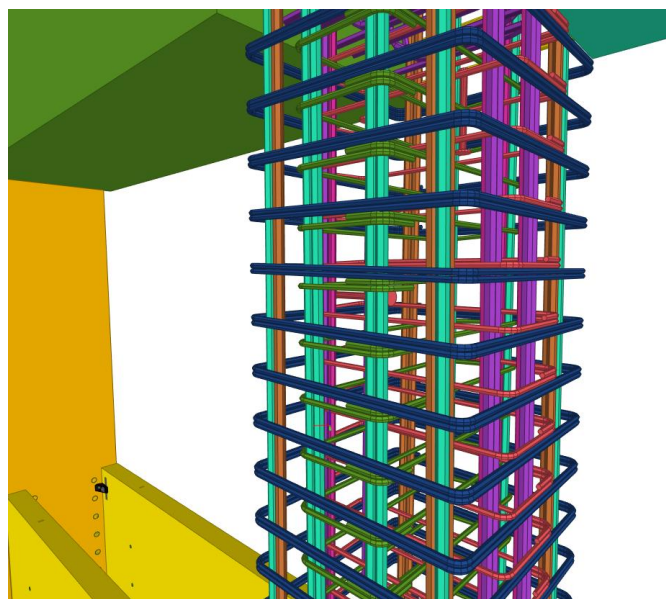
Vista 3D del modelado de la armadura de un pilar prefabricado de la pérgola 1
